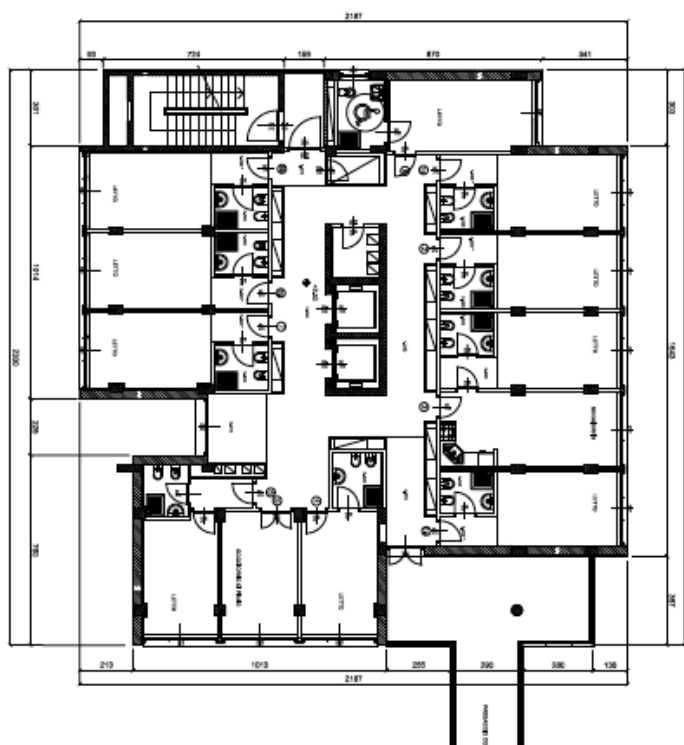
Pianta piano tipo corpo A (stanze) Campus Certosa – Fonte: *archivio In-Domus
